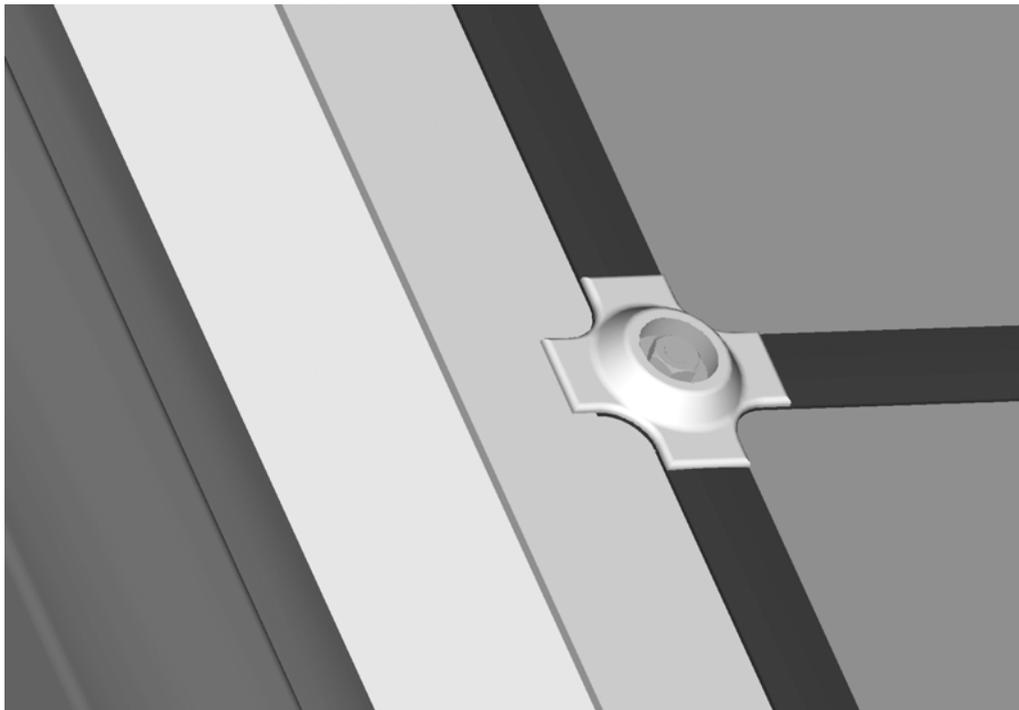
Eingebauter Niederhalter am seitlichen Anschlussblech
